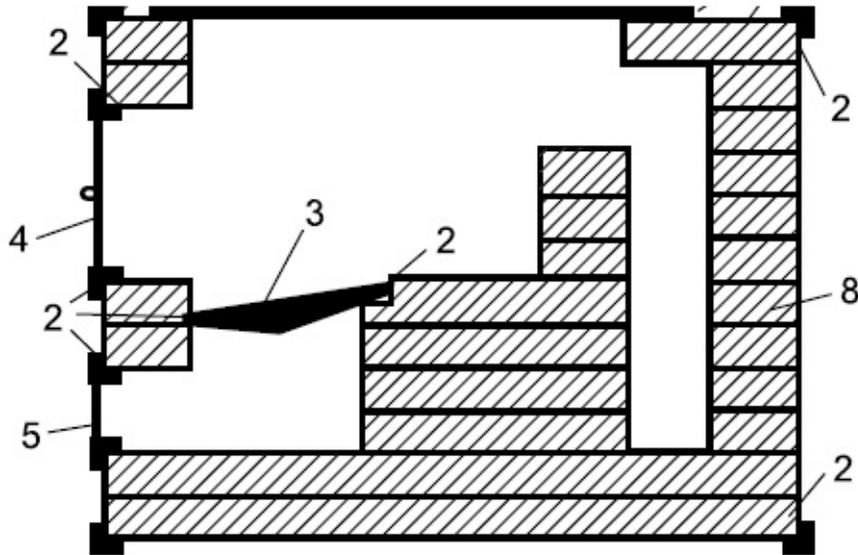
Установка печных приборов: 1 – плита очажная; 2 – уплотнитель; 3 – колосник; 4 – дверка топочная; 5 – дверка поддувальная; 6 – стальной уголок; 7 – стальная пластина; 8 – кирпичная кладка
